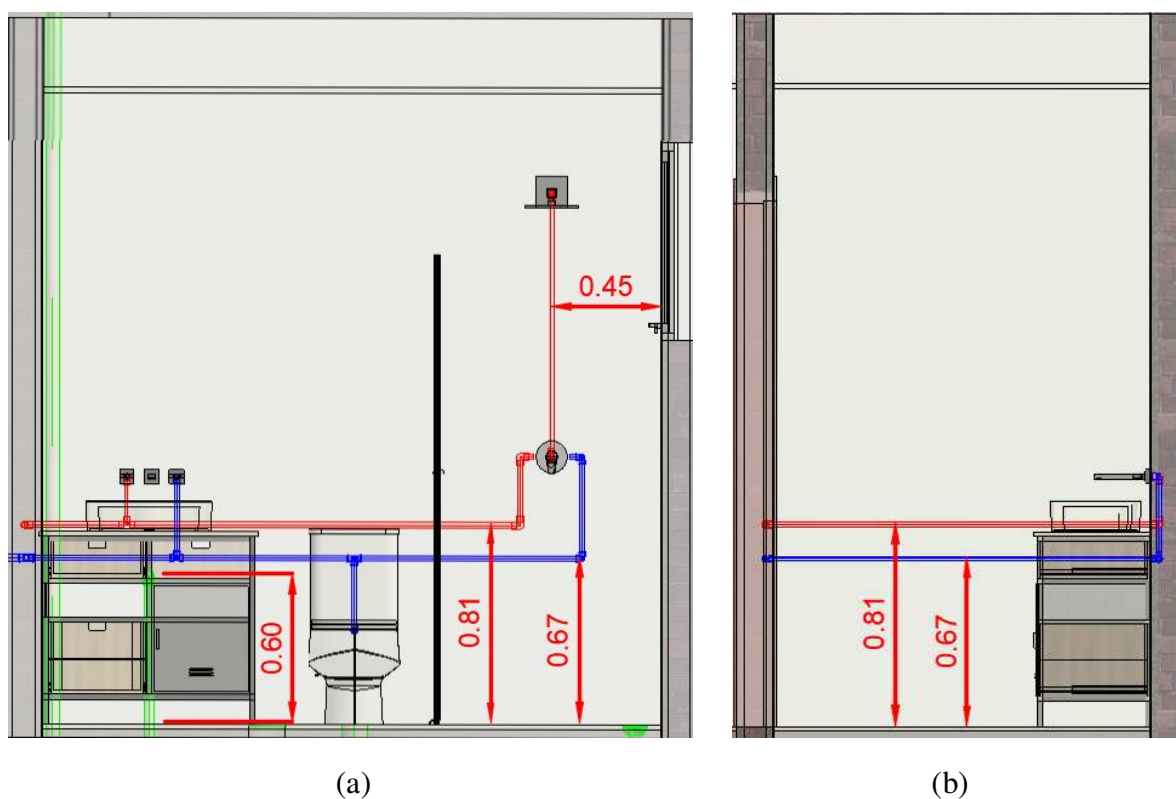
Instalações Hidrossanitárias Área de Serviço e WC Serviço: Corte frontal com vista da máquina de lavar, tanque, lavatório, vaso sanitário e chuveiro.
